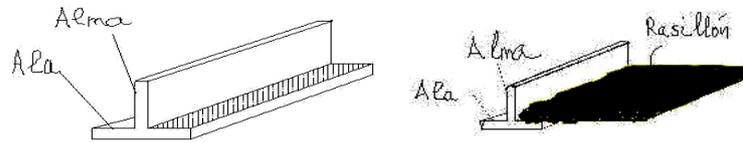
Perfil en T (www.ConstruAprende.com)
